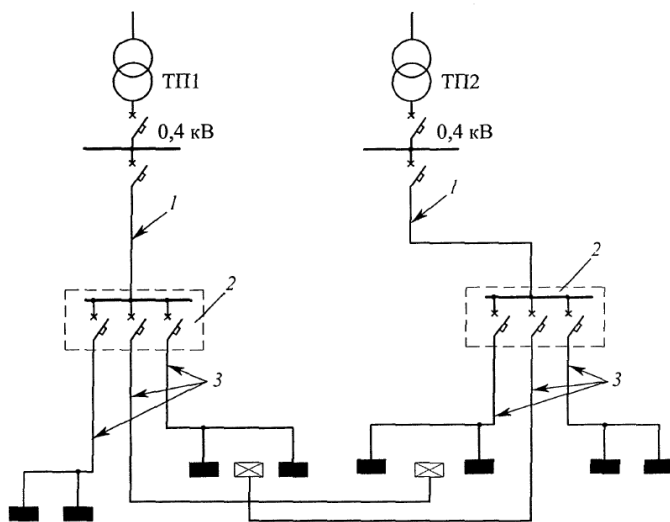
Схема перекрестного питания освещения от двух трансформаторных подстанций: 1 – питающая сеть; 2 – щит освещения; 3 – распределительная сеть освещения
